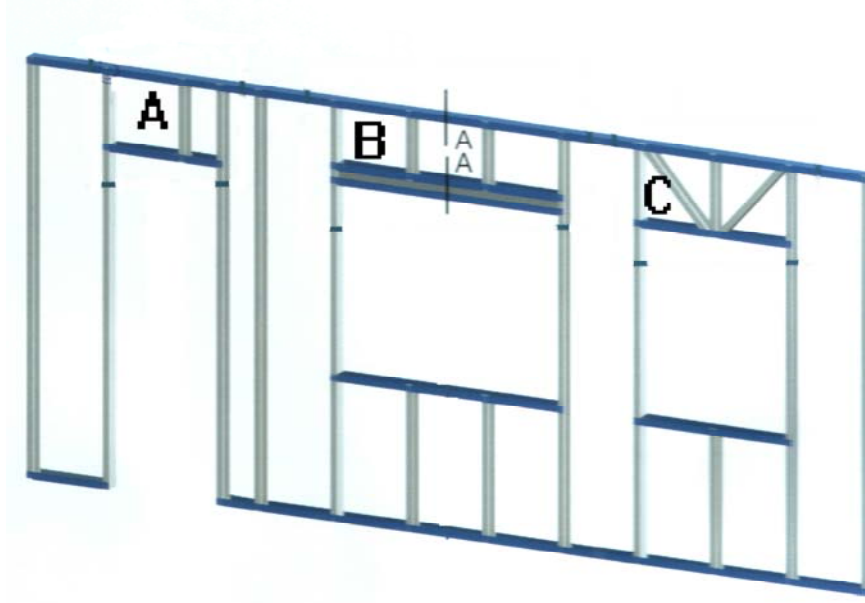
Başlıkta ek yapılması (NASFA, 2000)
